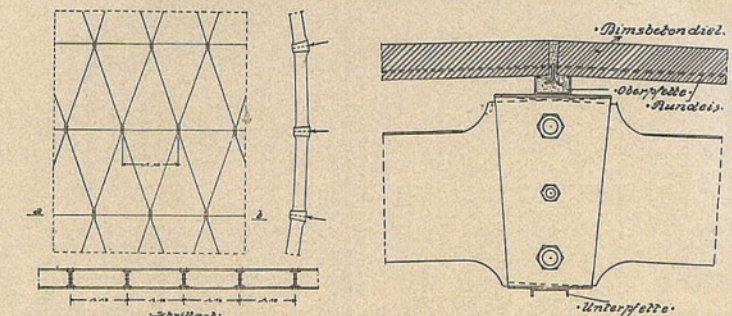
Schema des Lamellendaches u. Schnitt a–b.
